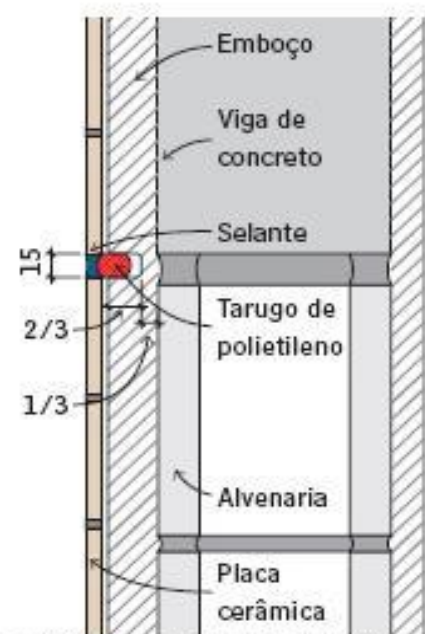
Detalhe da junta horizontal de movimentação (Medeiros, 2006).
